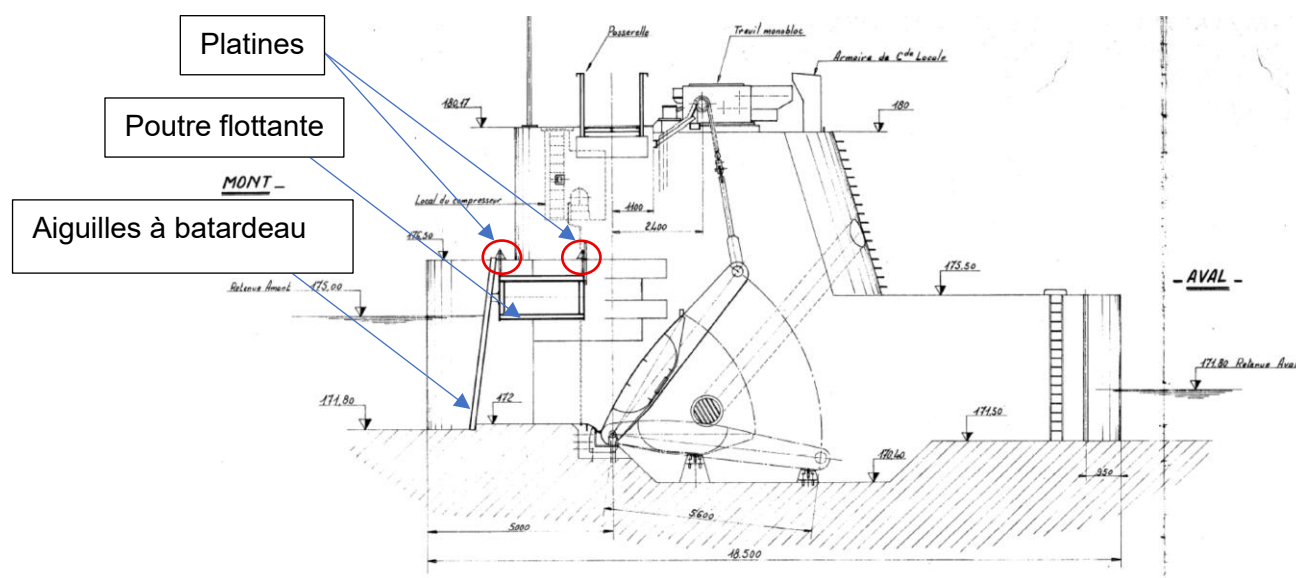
Coupe type barrage de Charnay (avec batardage) – (plan avec repère orthométrique)
